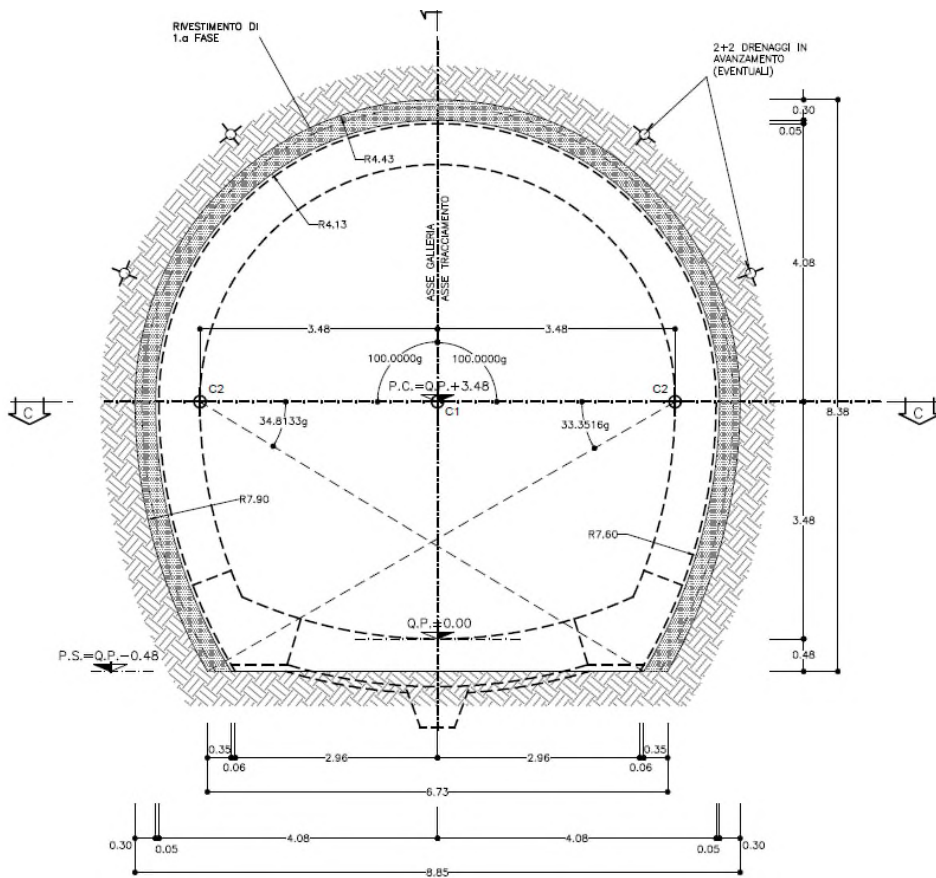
Sezione Tipo B0 – Scavi e consolidamenti - Sezione
